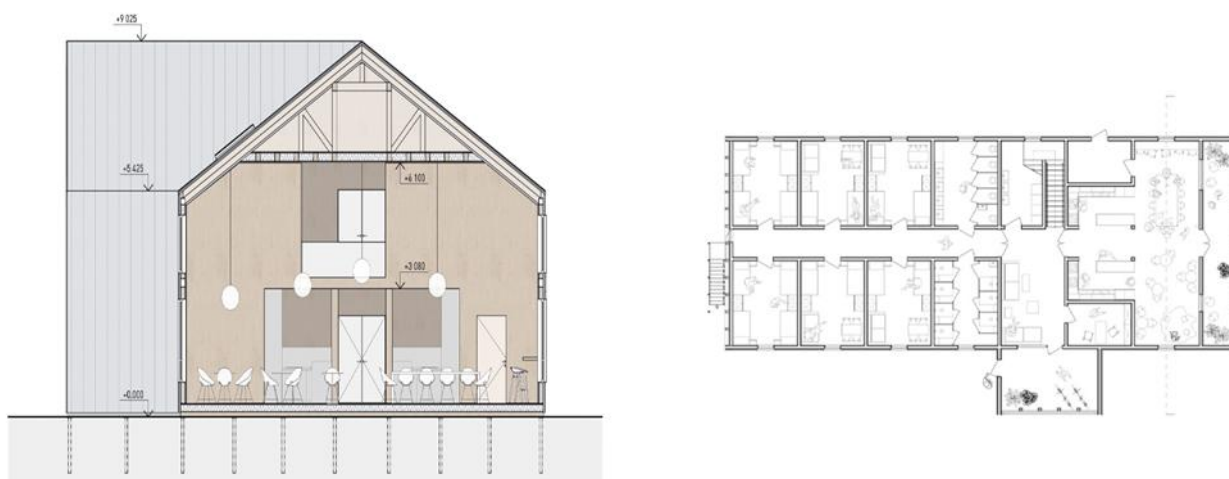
Фрагмент планування та розріз будівлі [1]
